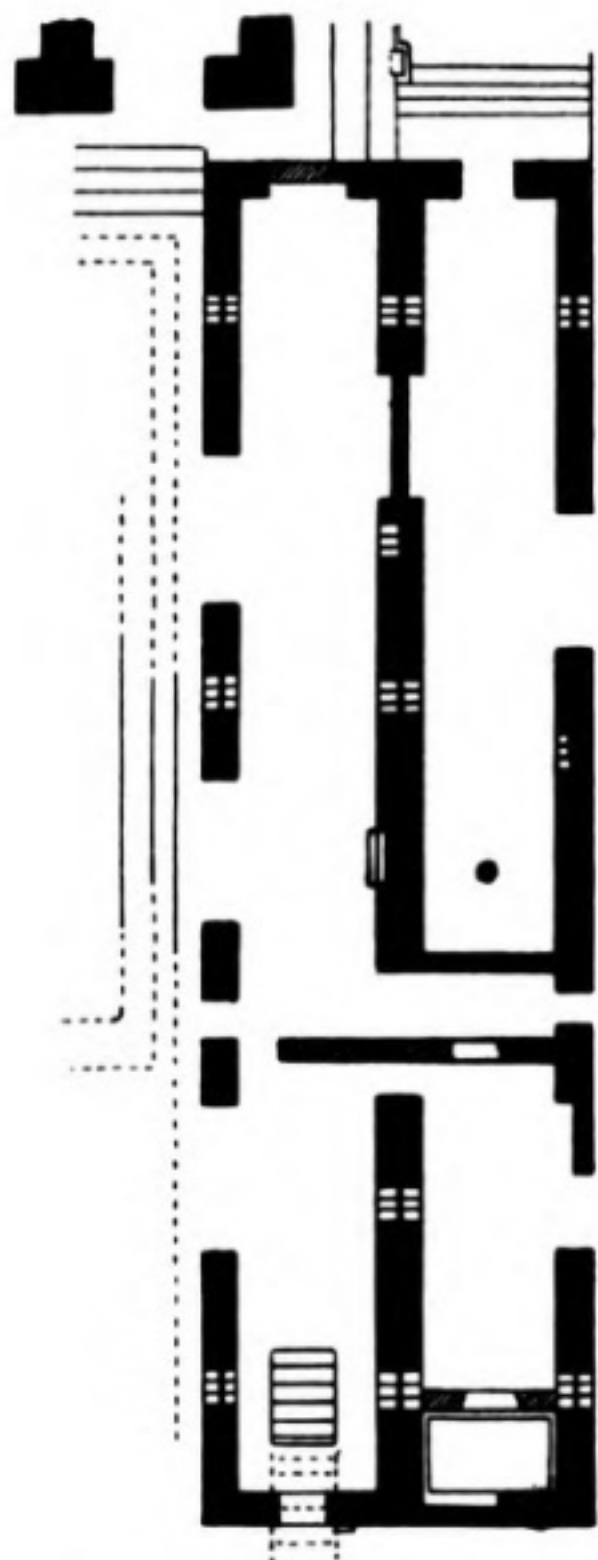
Palenque, Palacio. Alter Bau mit den Malereien (Haus *E*, Maudslay). Grundriß. (Nach Maudslay IV, Pl. 41.)
